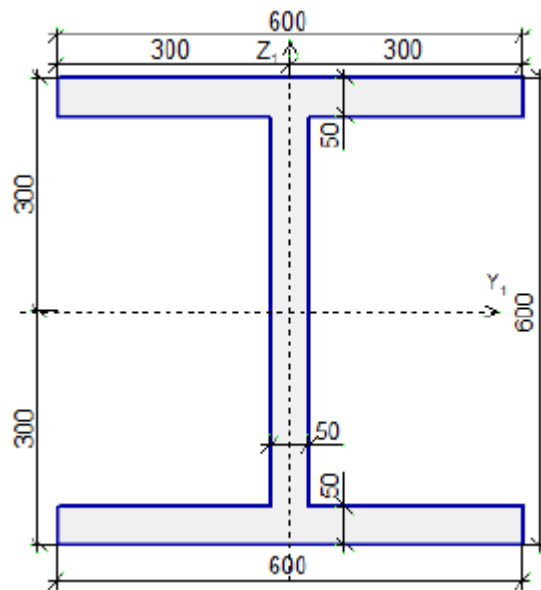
Сечение верхнего пояса фермы рамы
